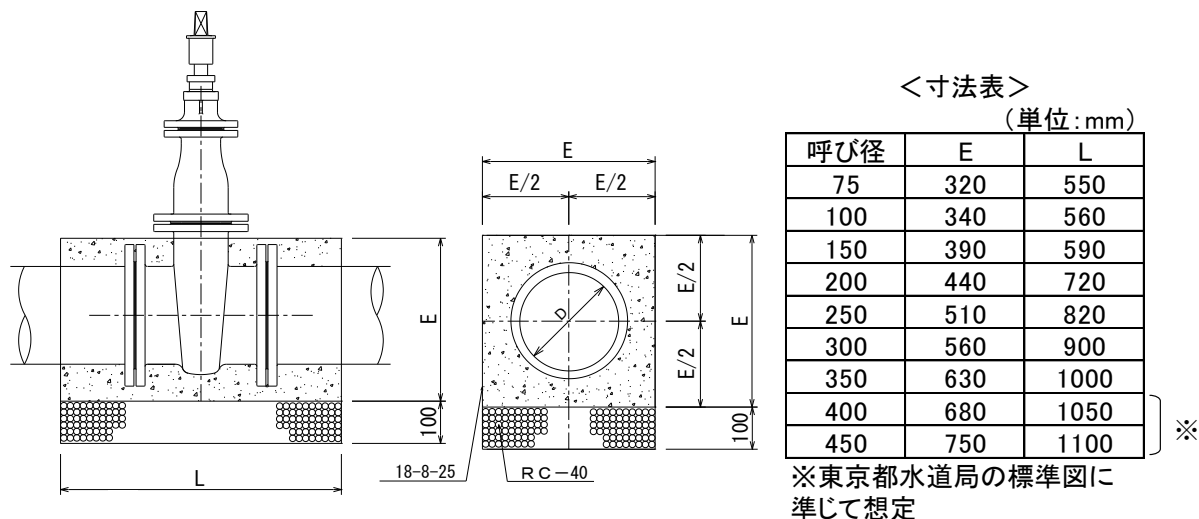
フランジ形バルブ(既存)コンクリート防護図
